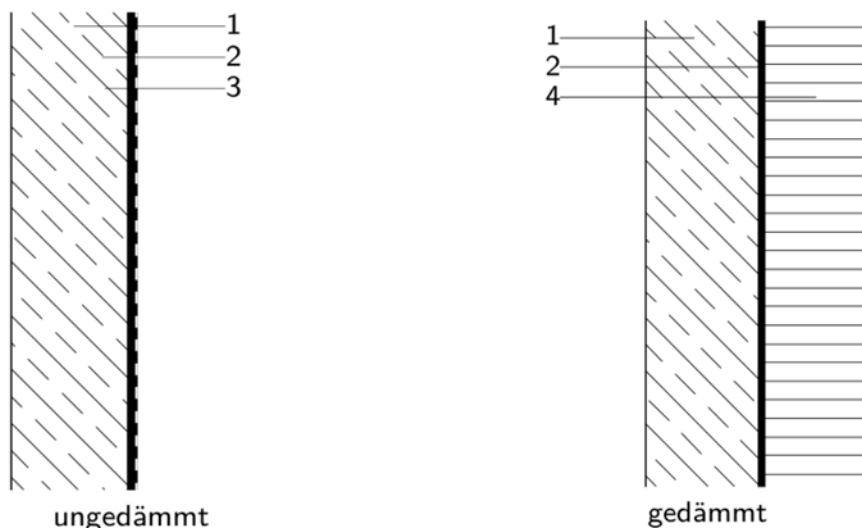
Bauteilaufbau Variante K01, Wand, gedämmt / ungedämmt
